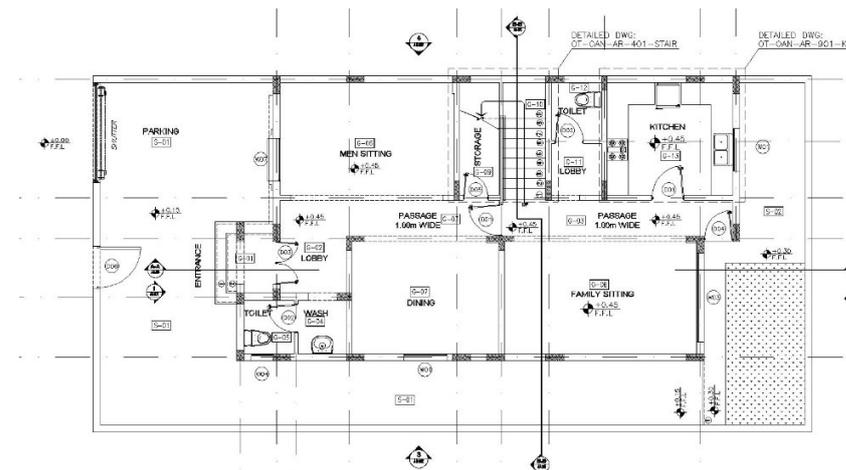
Planta alta arquitectónica. Proyecto Al Otaibi
